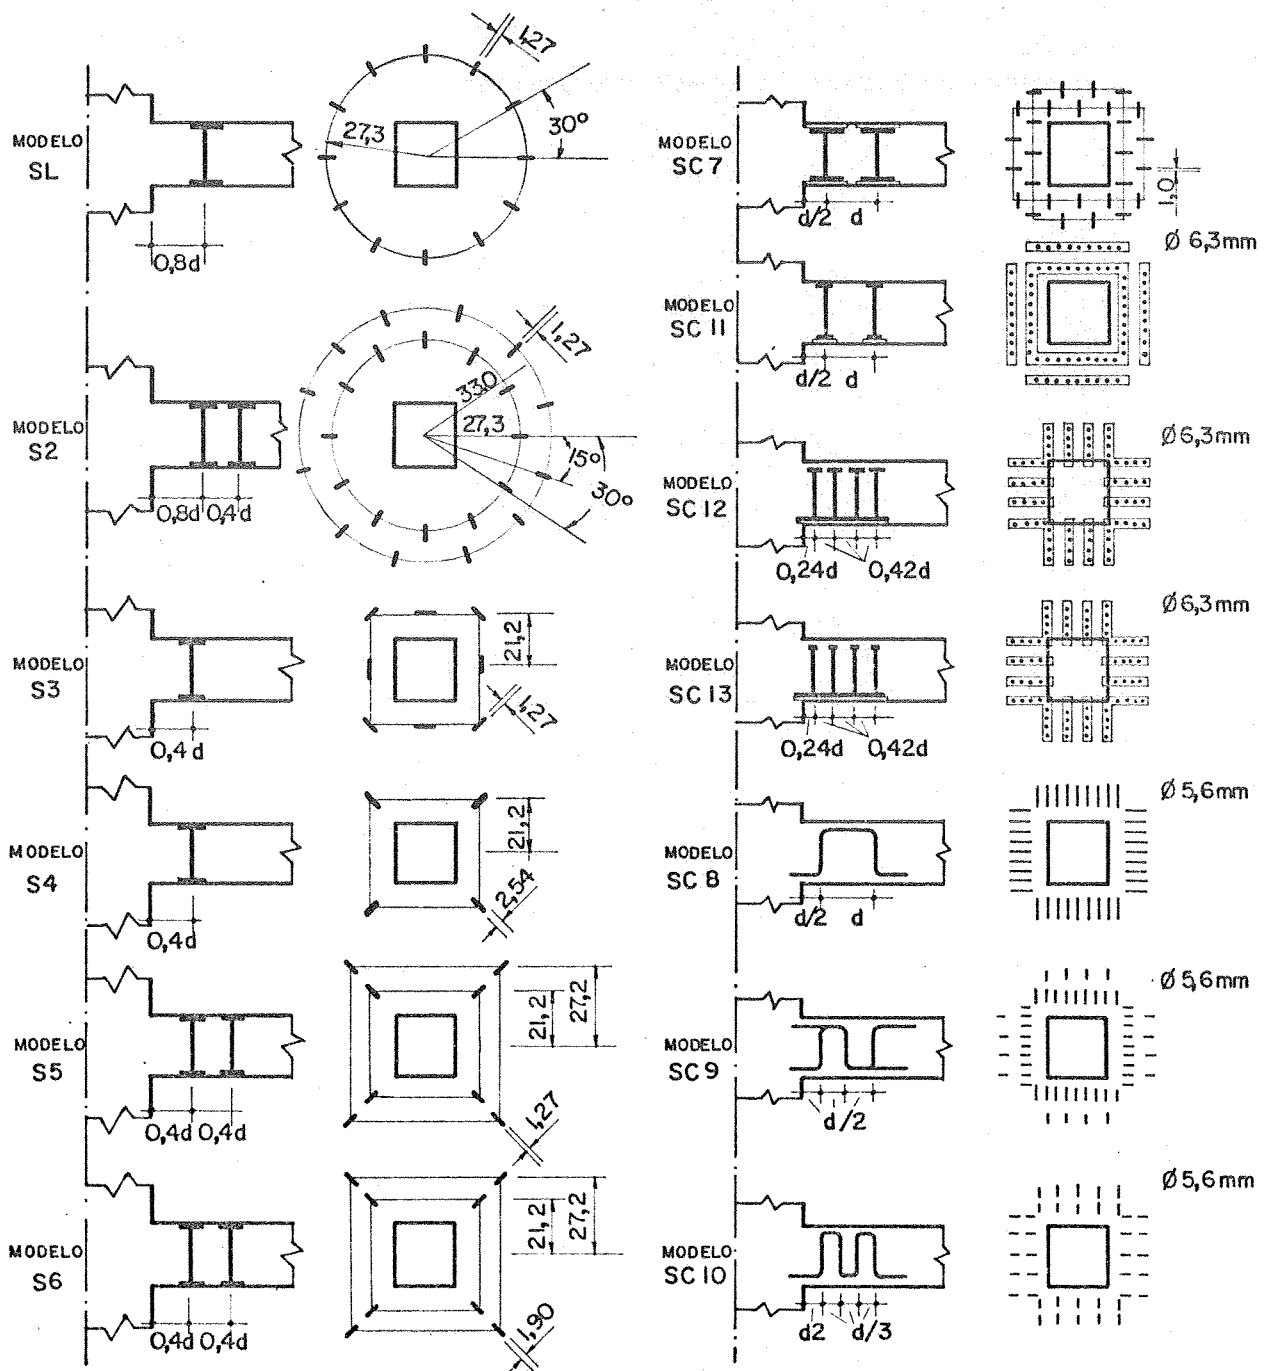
TIPOS DE ARMADURAS TRANSVERSAIS UTILIZADAS POR GHALI E DILGER
